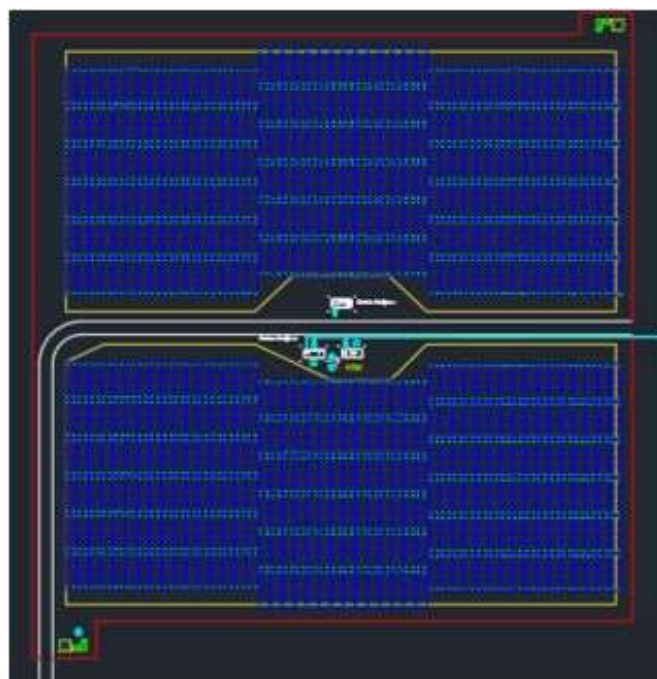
Vista en planta de la central fotovoltaica (400 estructuras con 22 módulos cada una) con 17° de inclinación y azimut 0°.
